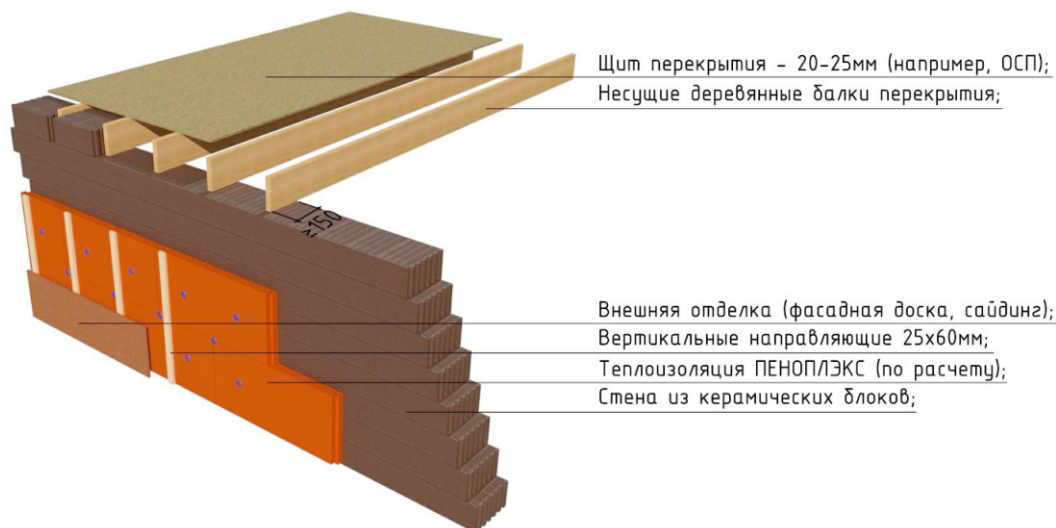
Схема сопряжения теплоизолированной стены из керамических блоков с деревянным перекрытием.
